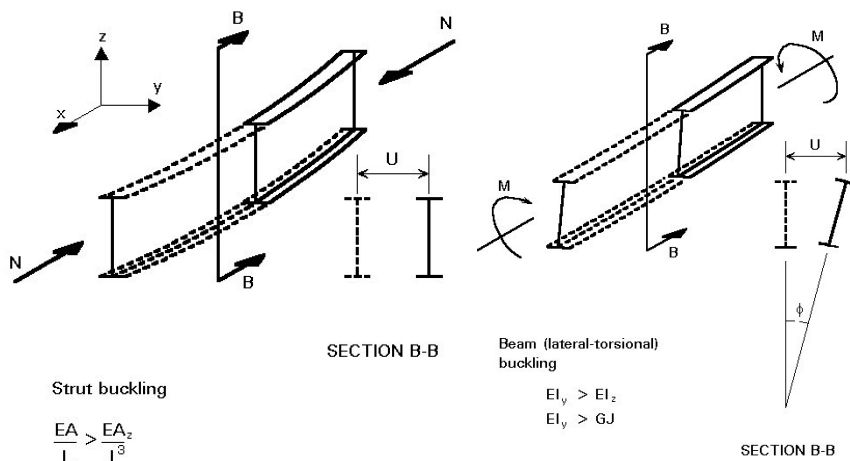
Similarité entre flambement d'une colonne et déversement d'une poutre.
